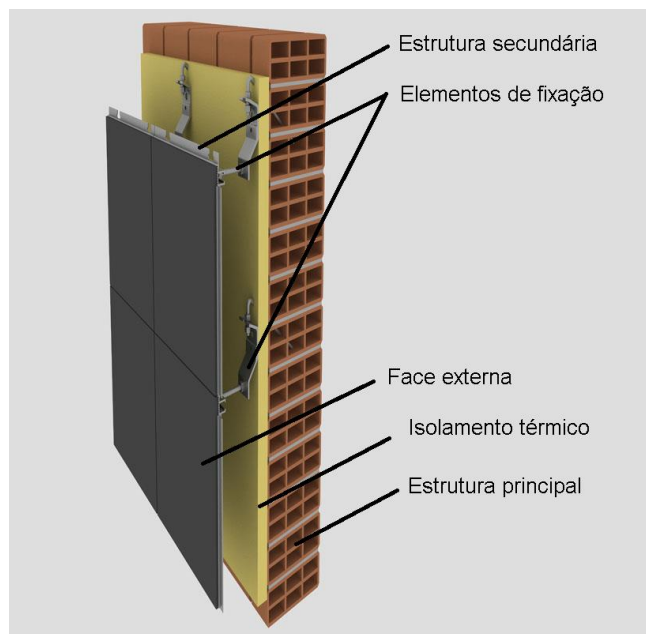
Esquema de corte de uma fachada leve. Adaptado de [9]
